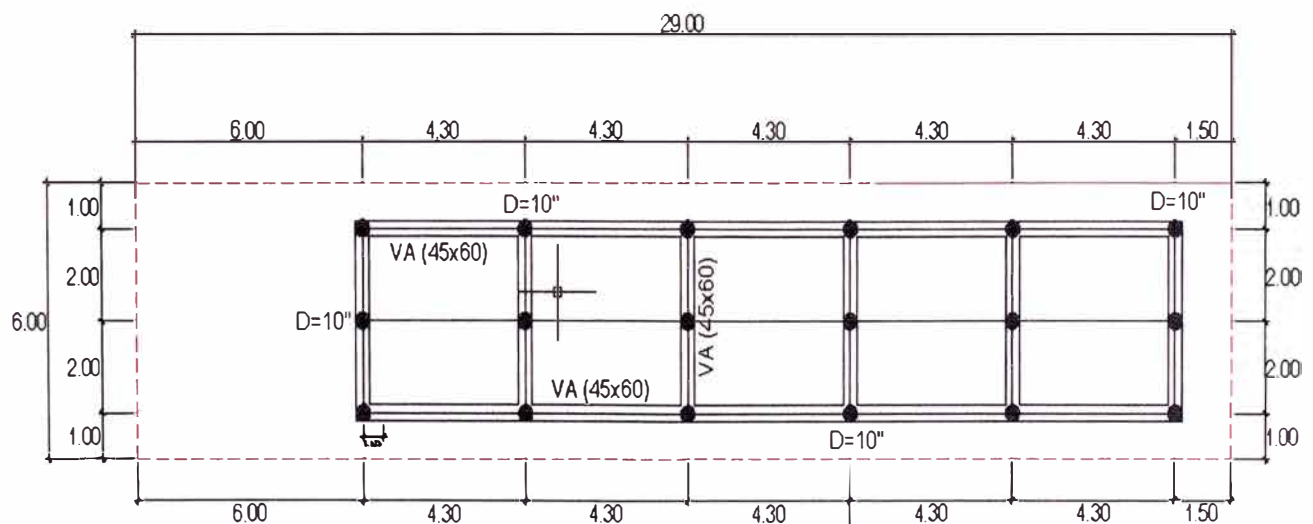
Distribución de pilotes y vigas de arriostre en el 1er tramo
